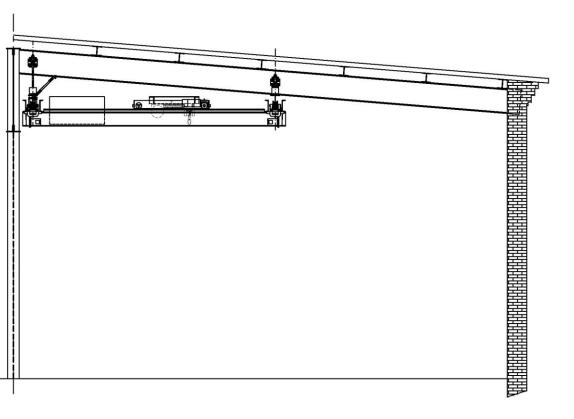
Sección de caída (Sección de elevación)
